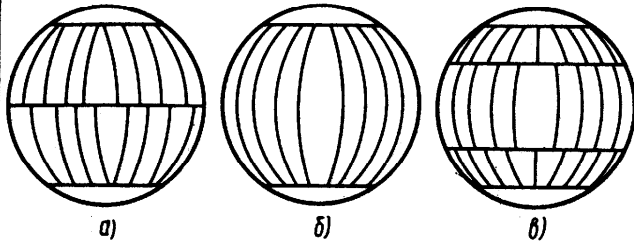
Схемы раскроя корпусов сферических резервуаров
